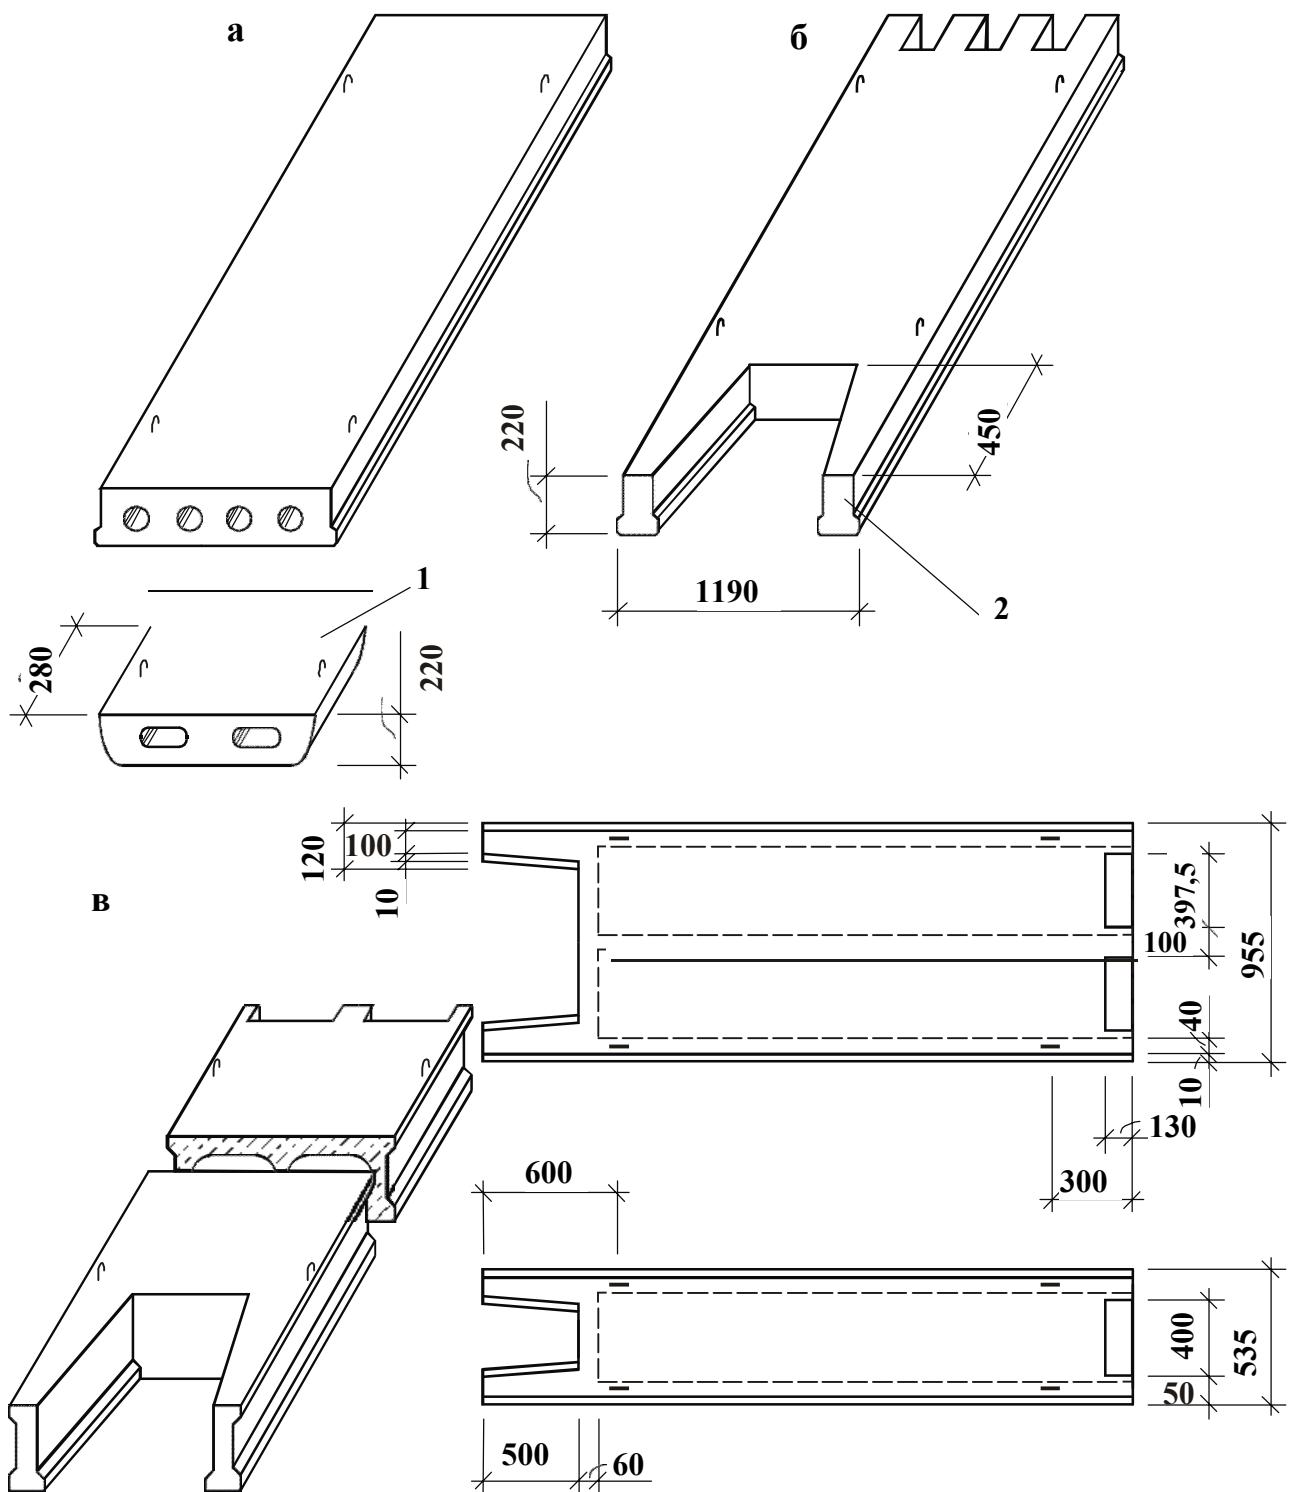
Великорозмірні залізобетонні конструкції перекриттів:
